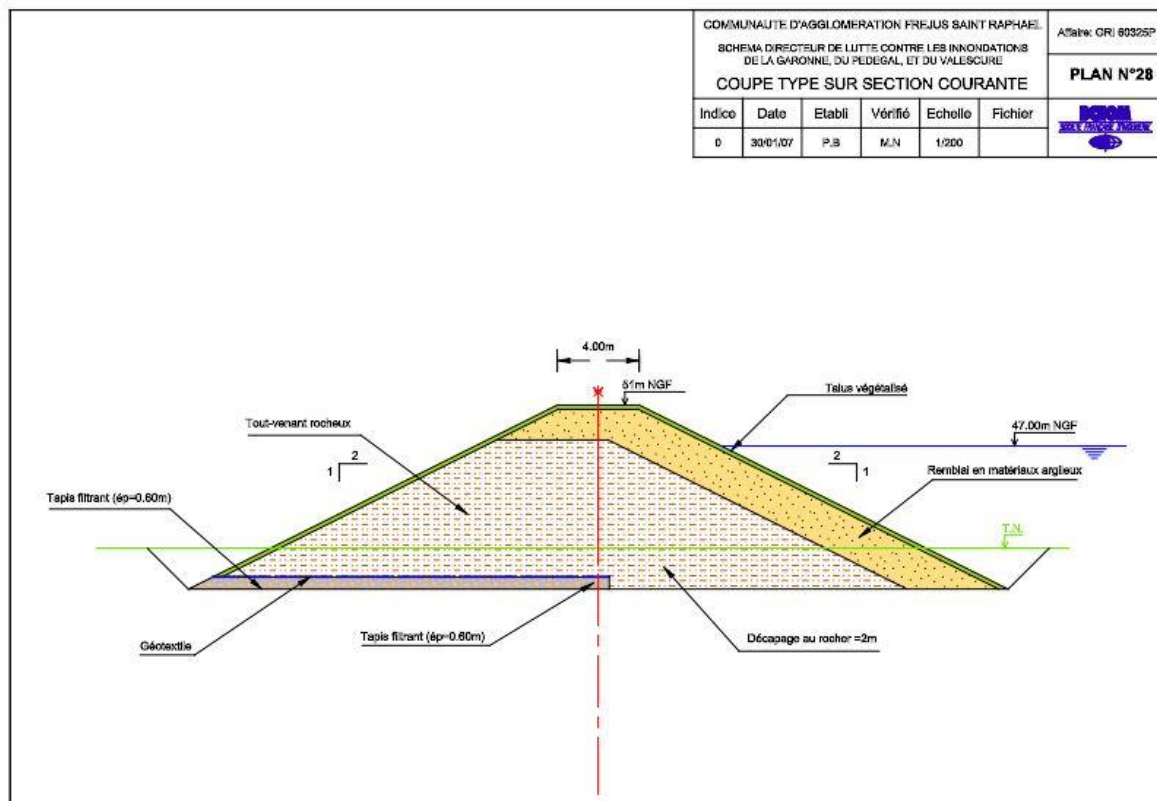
Plan en coupe au niveau de la section courante (Source : CAVEM)
